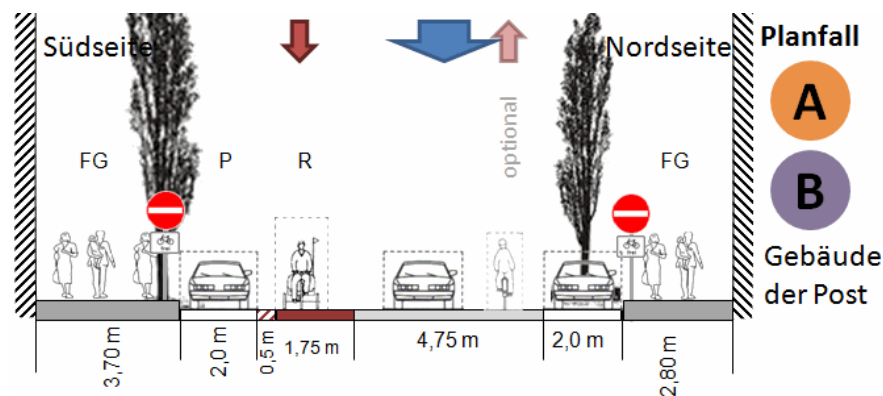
Ausführungen mit baulichen Radweg in der Deisenhofener Straße (Planfall A)
